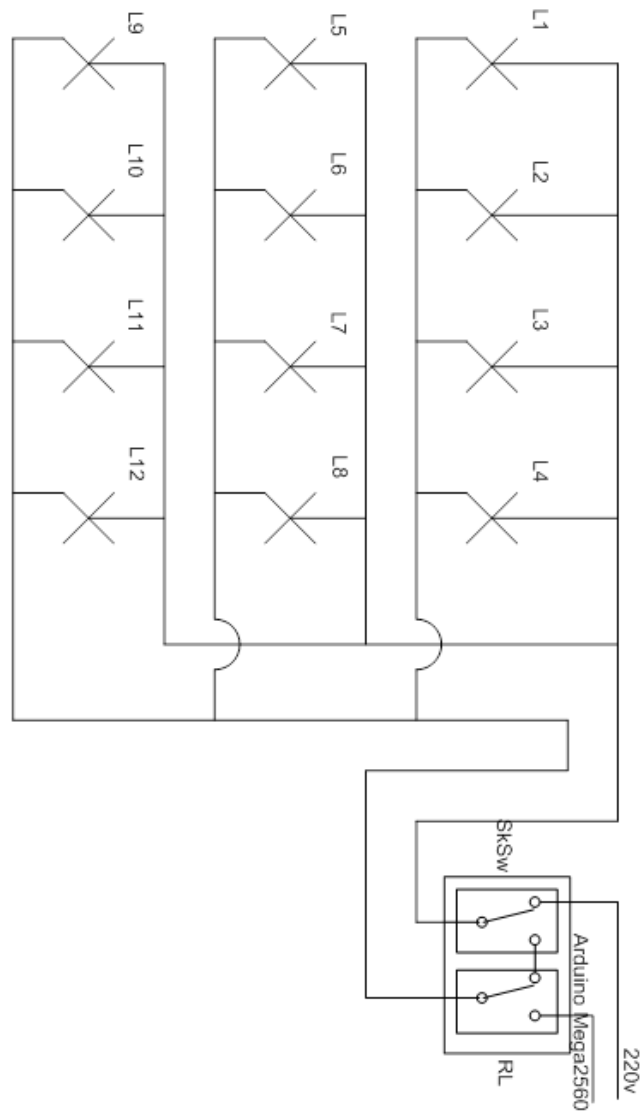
Single Line* Diagram Ruang Kelas Lantai 5 Raden Adjeng
